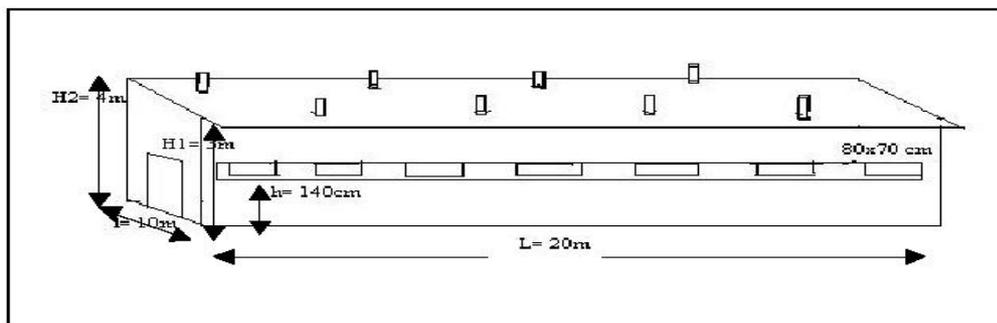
plan du bâtiment d'élevage (ISRA.1997)
